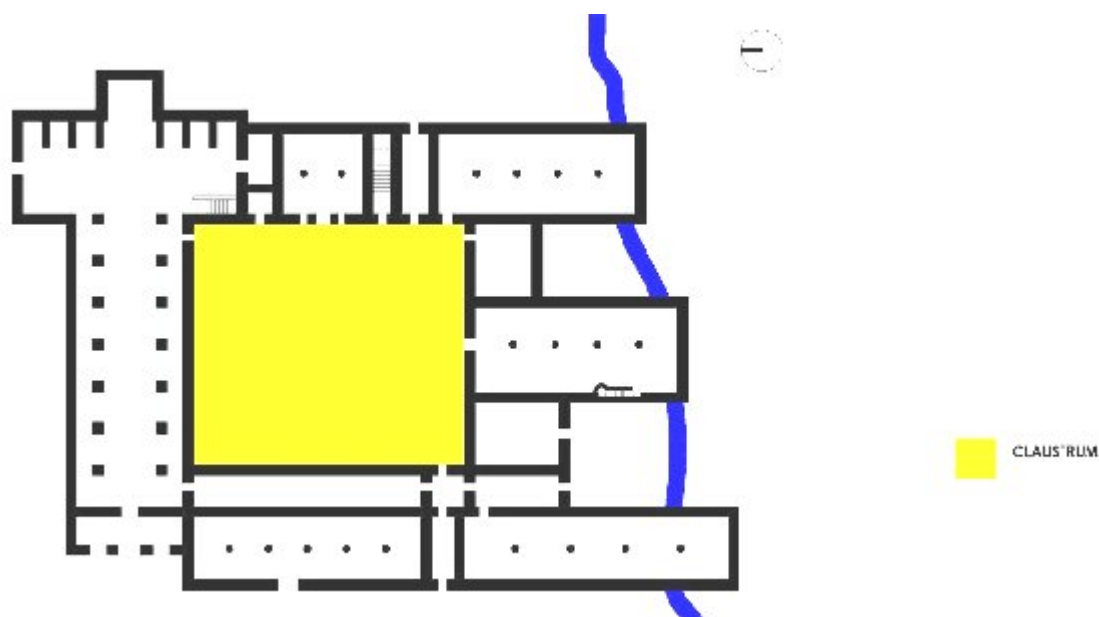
Planta de Santa Maria de Alcobaça desenhado por Ernesto Korrodi (DGEMN/IRHU)
